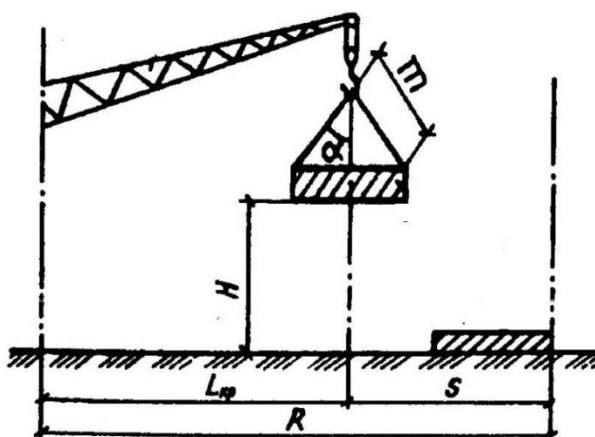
Схема определения границы опасной зоны башенного крана
